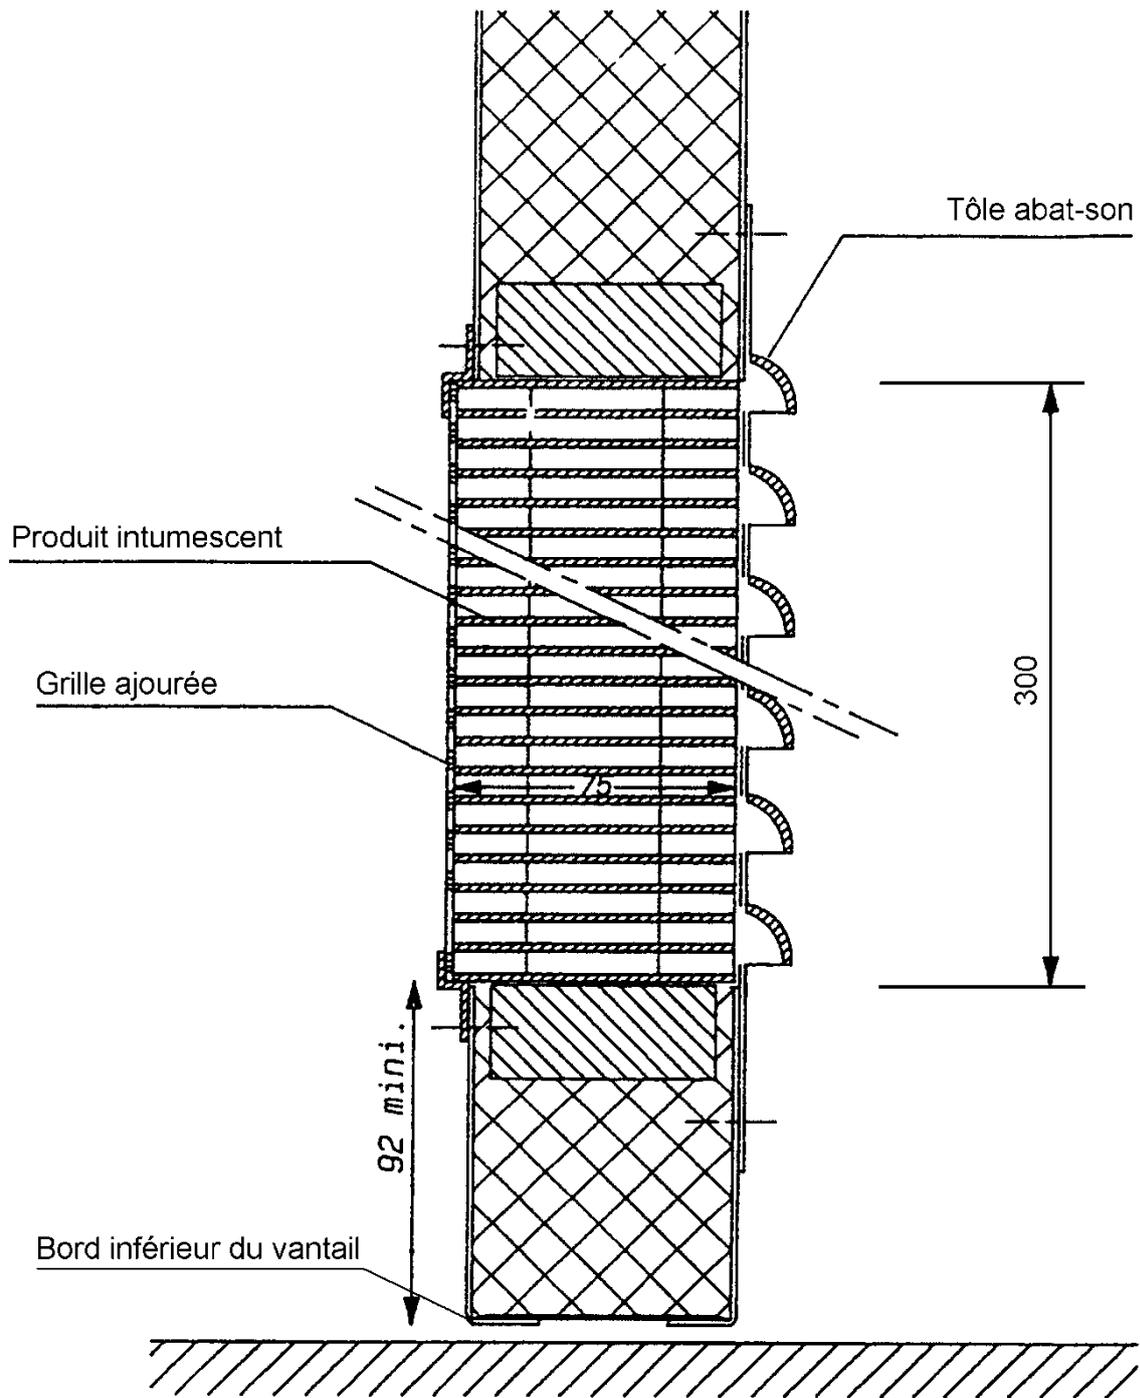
Coupe verticale de la grille de ventilation en bas du vantail
